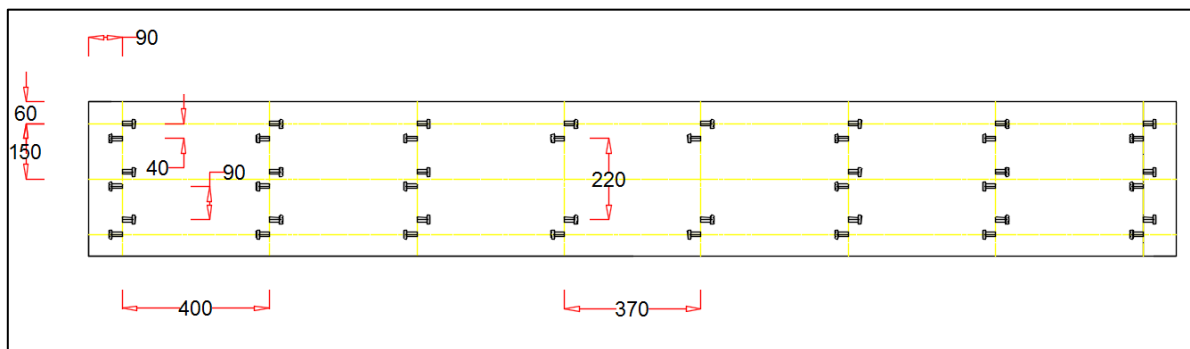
Espaciamento y disposición de tirafondos para la losa en flexión. (vista en planta).
